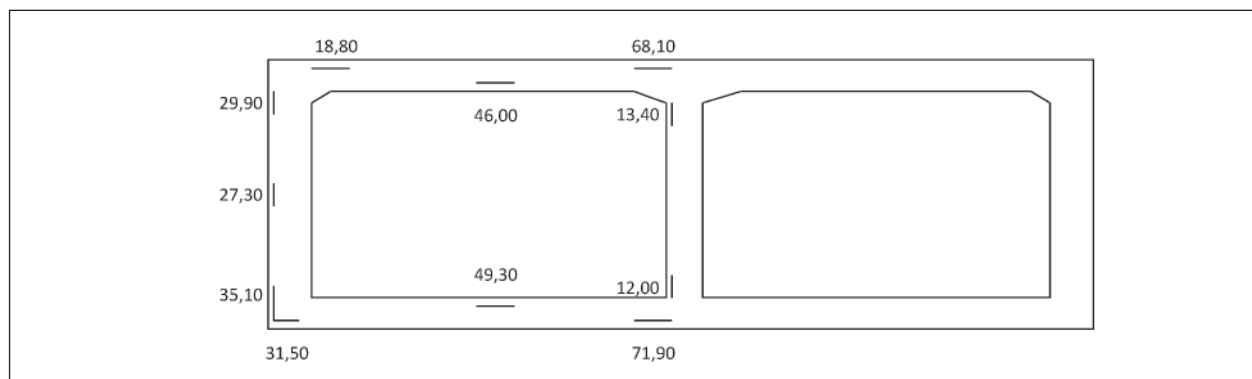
Tunnelquerschnitt RQ 26t mit maßgebender Bewehrung, Auflast 4,0 m
